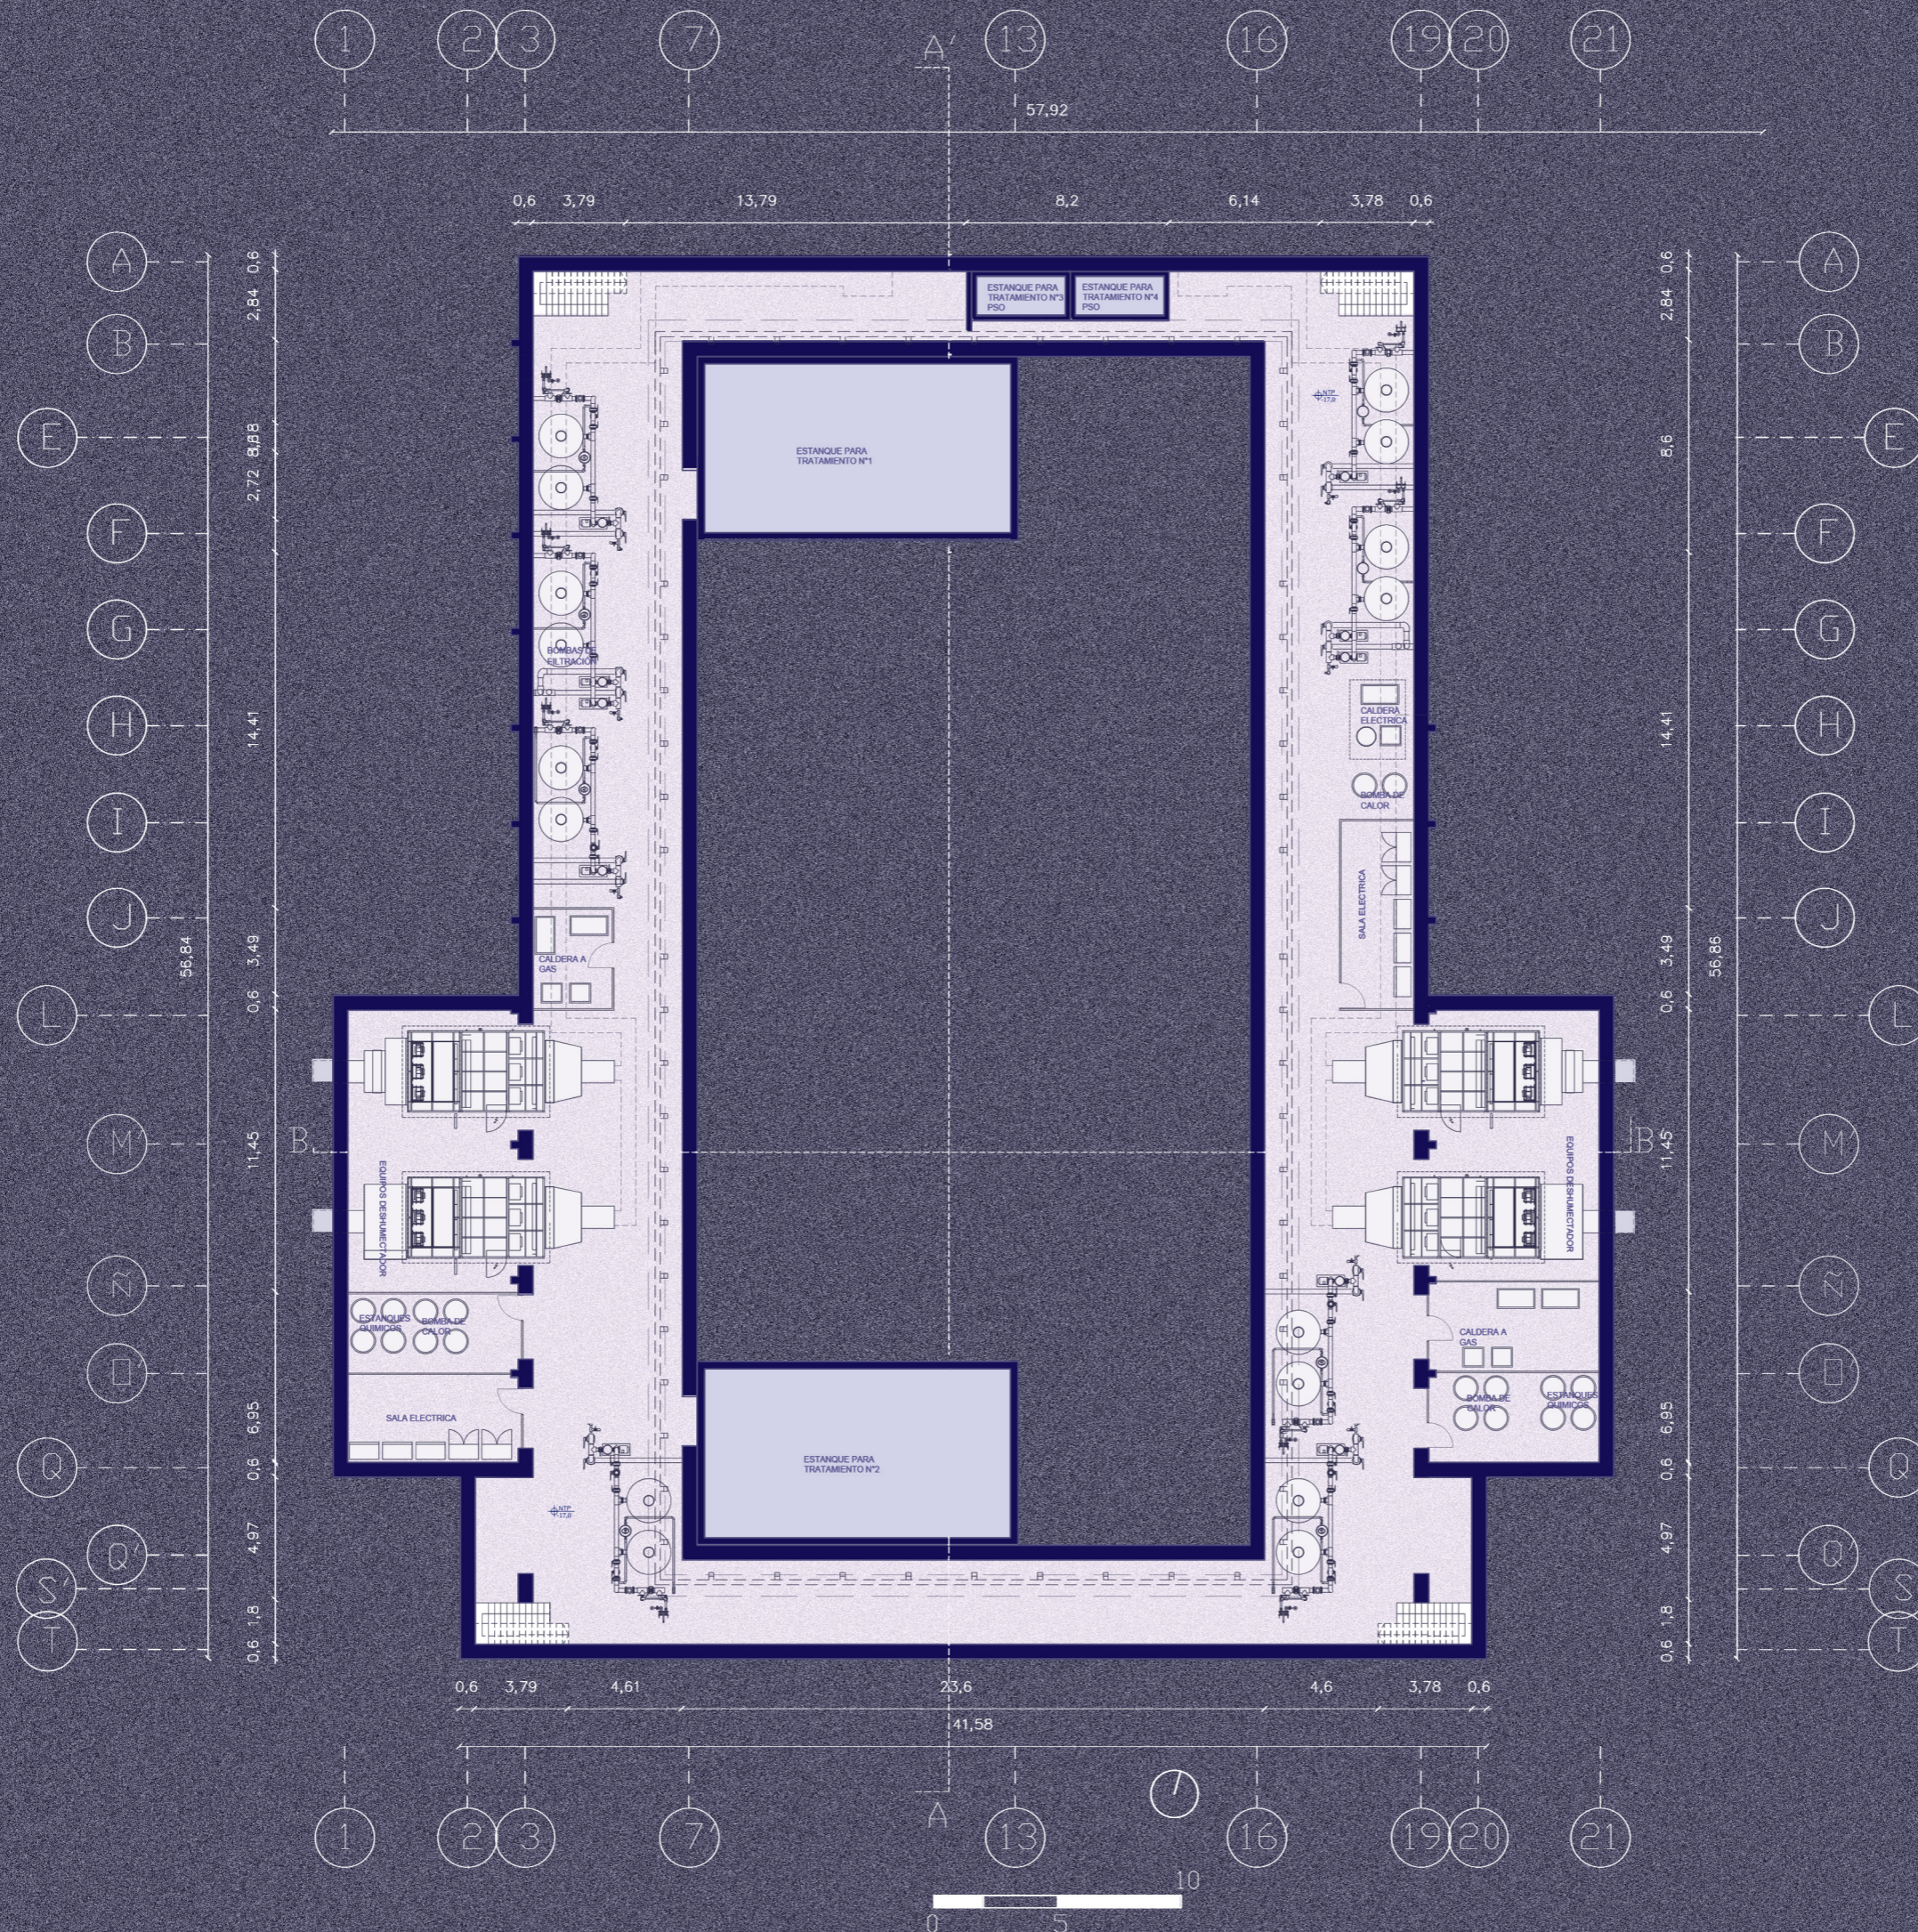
Planta N°-3, nivel -17.0. Fuente: Elaboración propia
